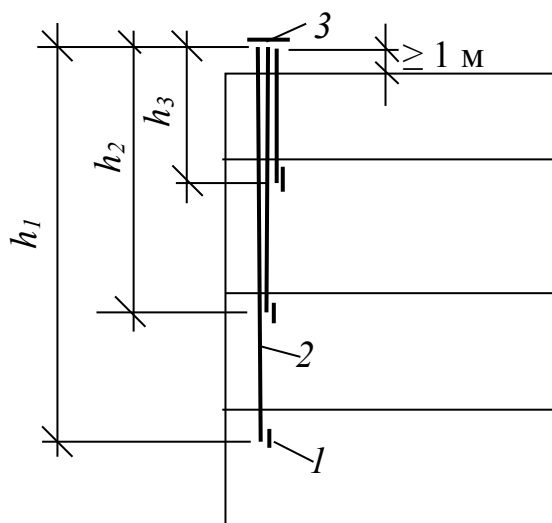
Система вытяжной естественной канальной вентиляции малоэтажного здания
